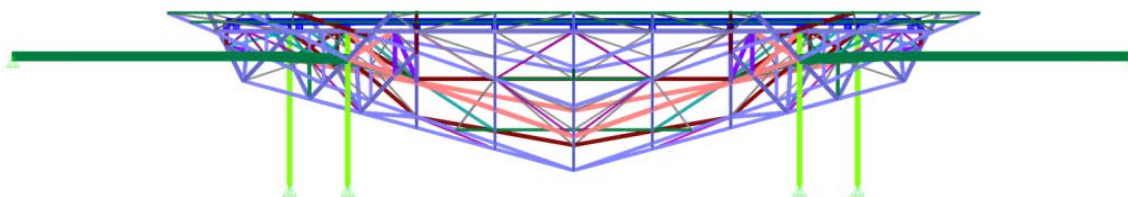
Vista em elevação do modelo de cálculo 3D.
